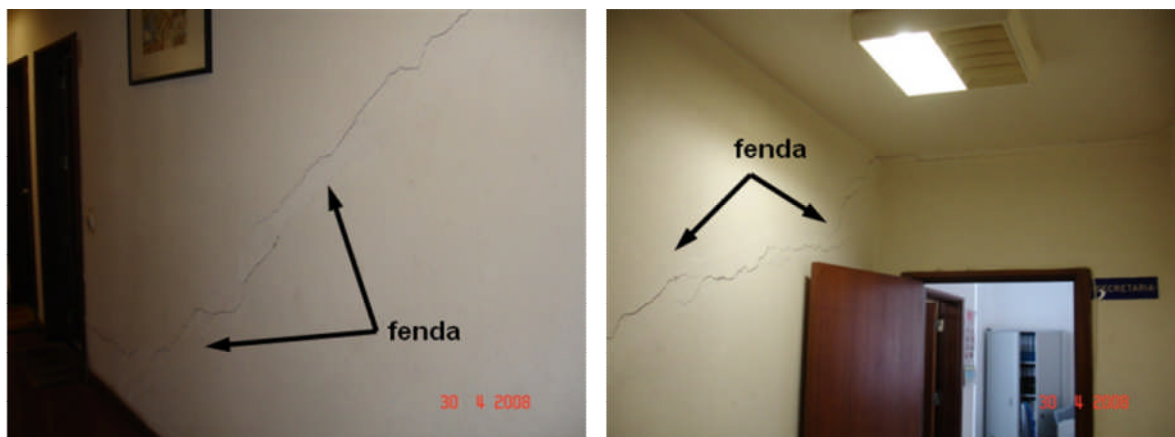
Fendas em paredes de alvenaria causadas por deformação excessiva da laje fungiforme.
